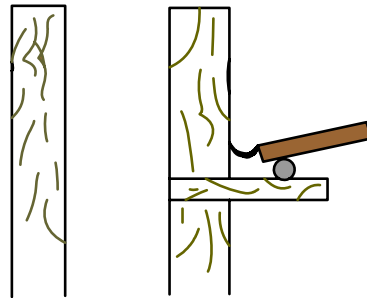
Infiltração em parede – Adaptada de VERÇOZA, 1991
